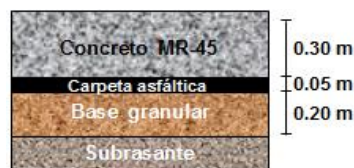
Estructura de pavimento carriles TransMilenio calzada occidental.
